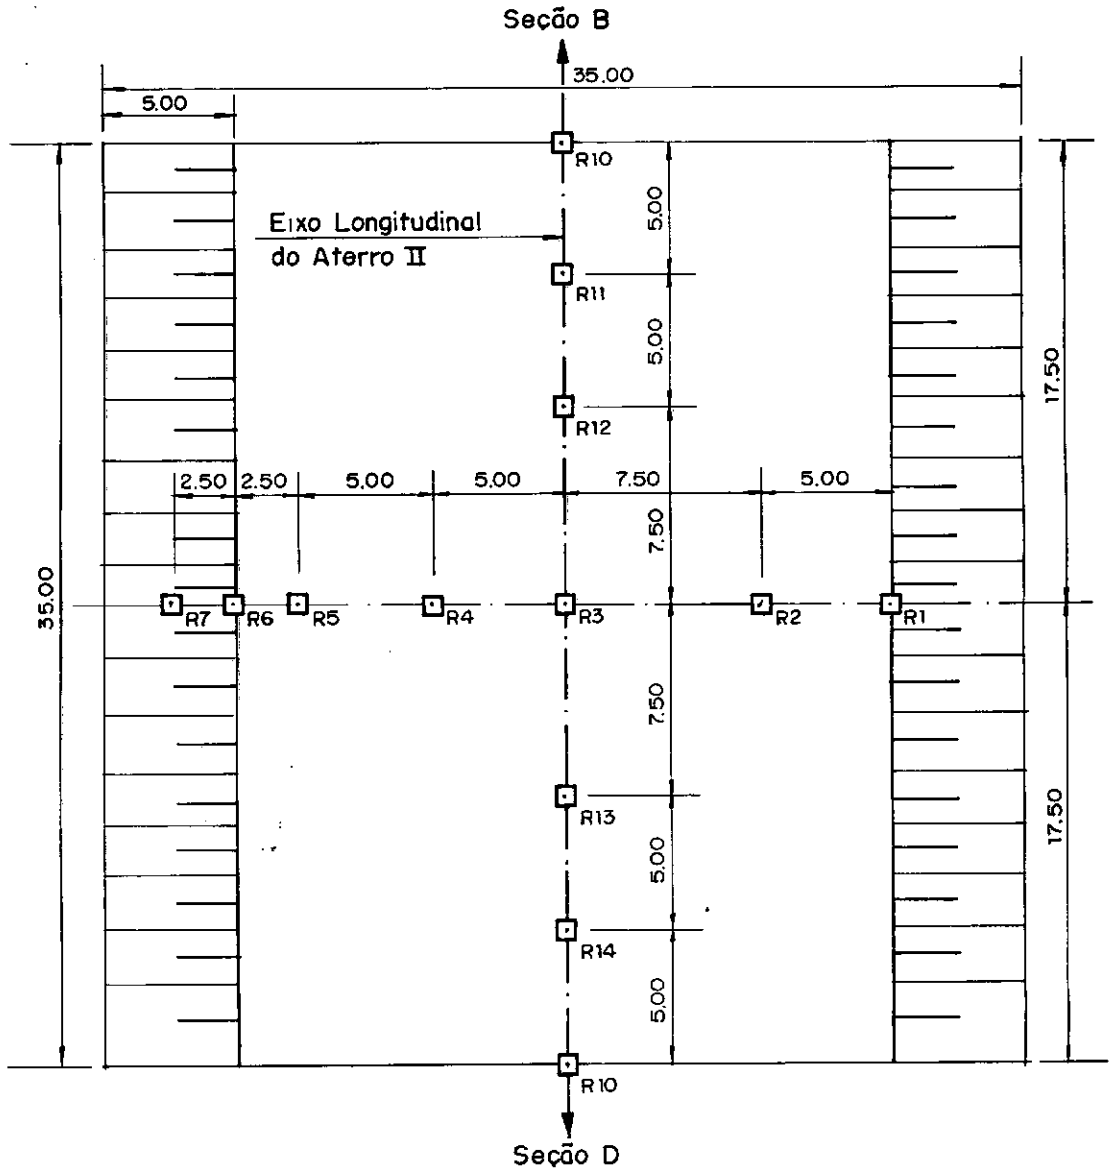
Localização das placas de recalque em planta - Seção C.
